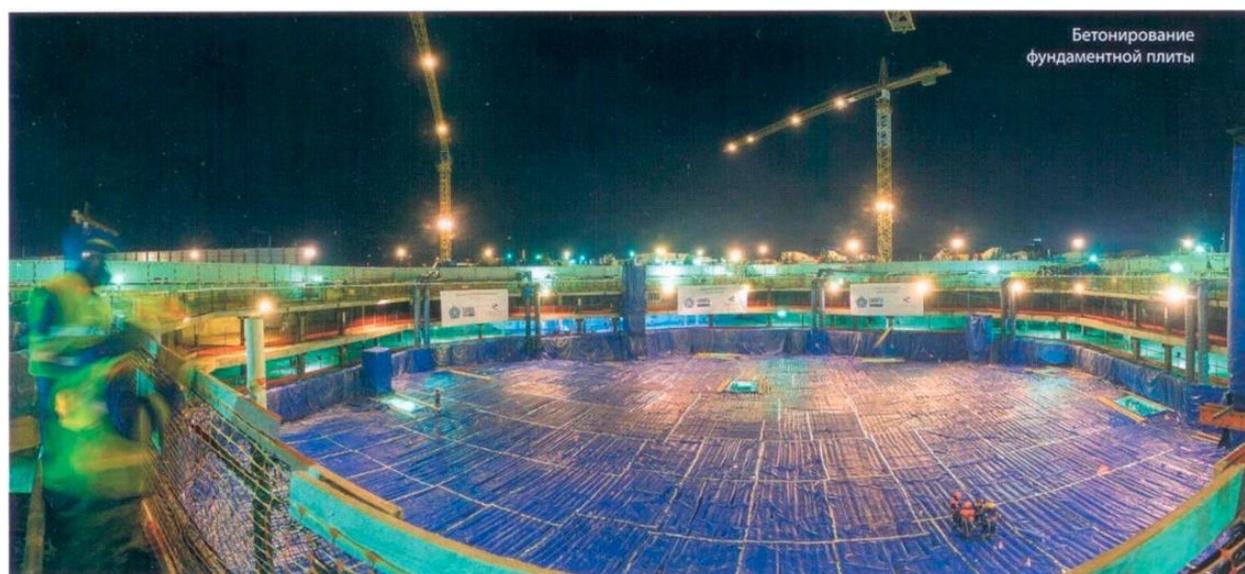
Бетонирование фундаментной плиты коробчатого фундамента
